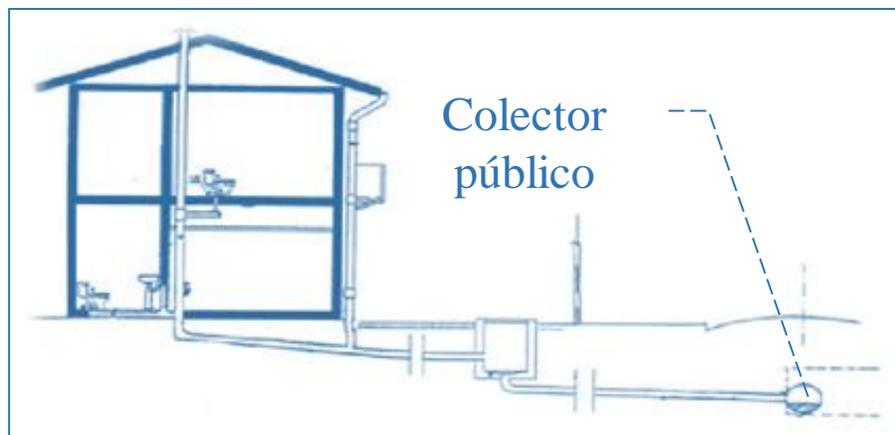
Instalación de alcantarillado domiciliario conectado al colector público.
